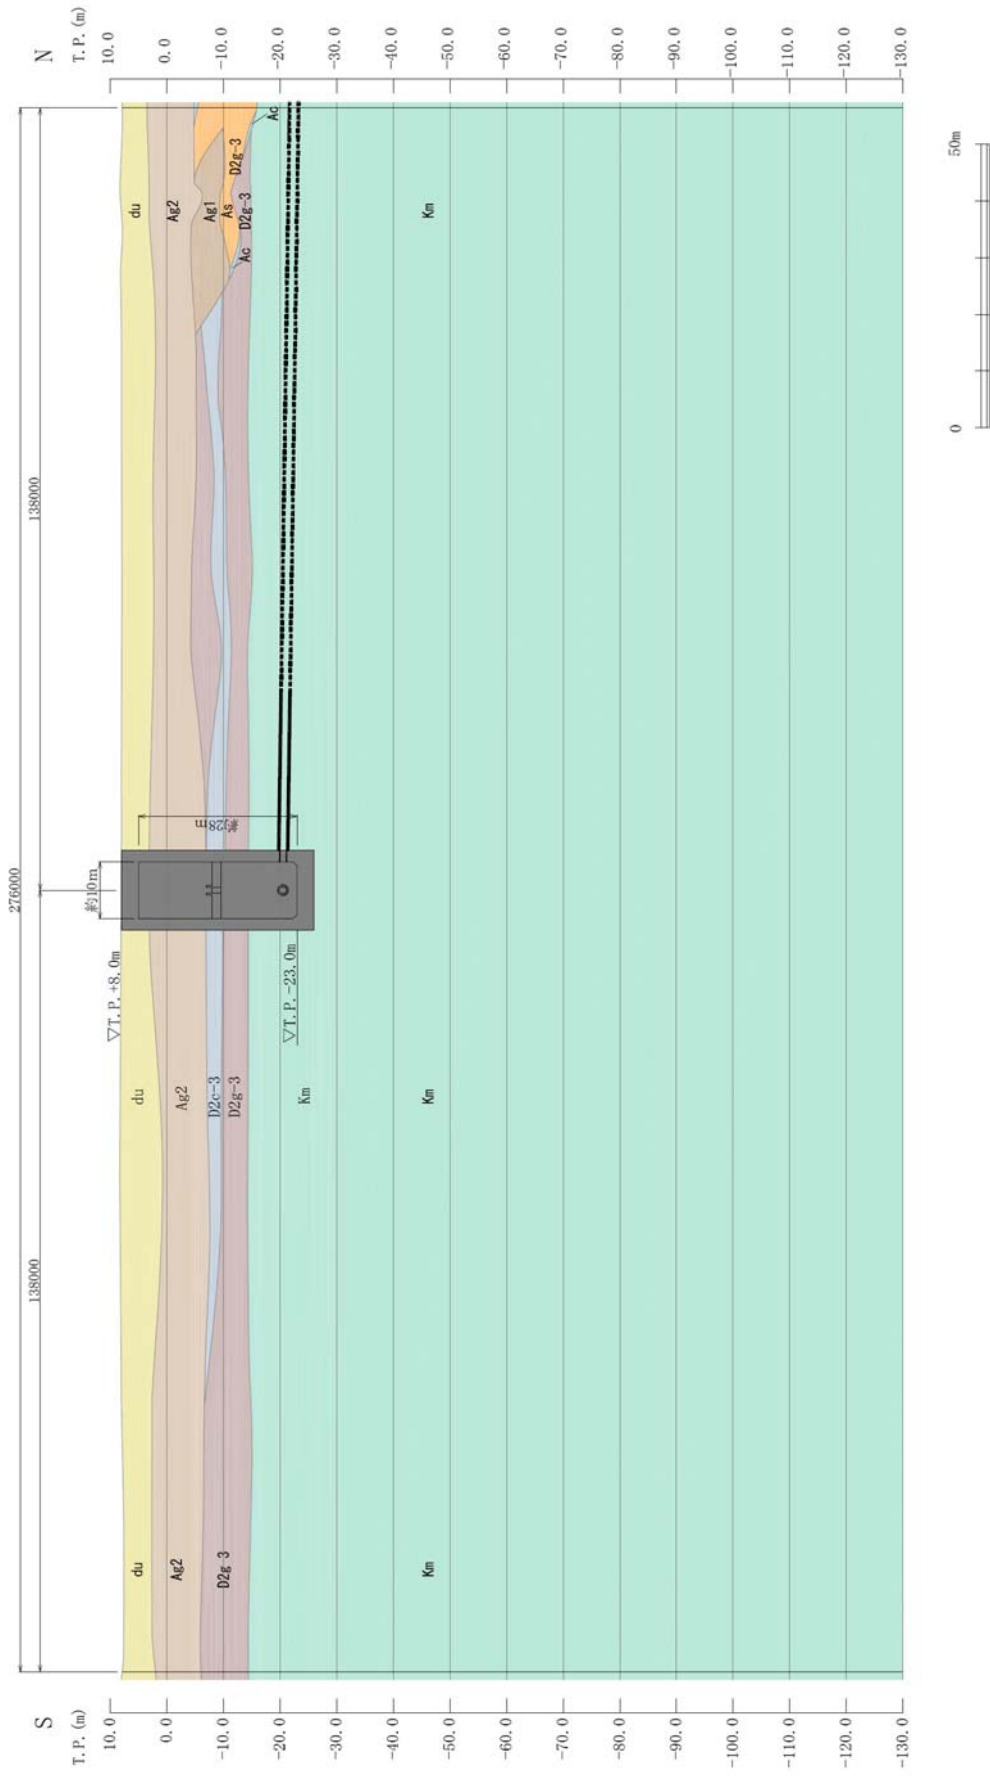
(3) SA用海水ピット 評価対象断面図 (②-②断面)
